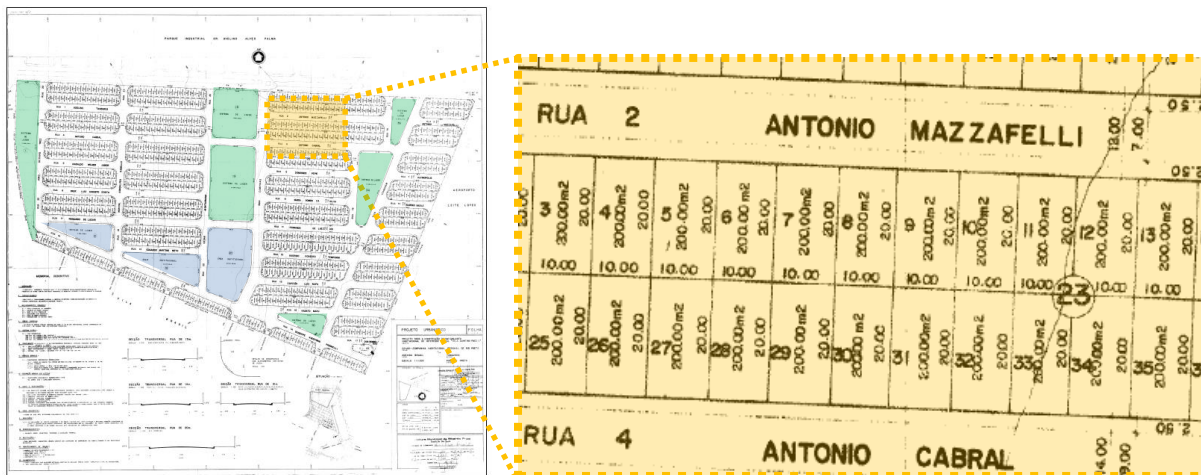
Conjunto Habitacional Quintino Facci 1 implantado pela COHAB-RP - subsetor Norte 11 na década de 1970.
